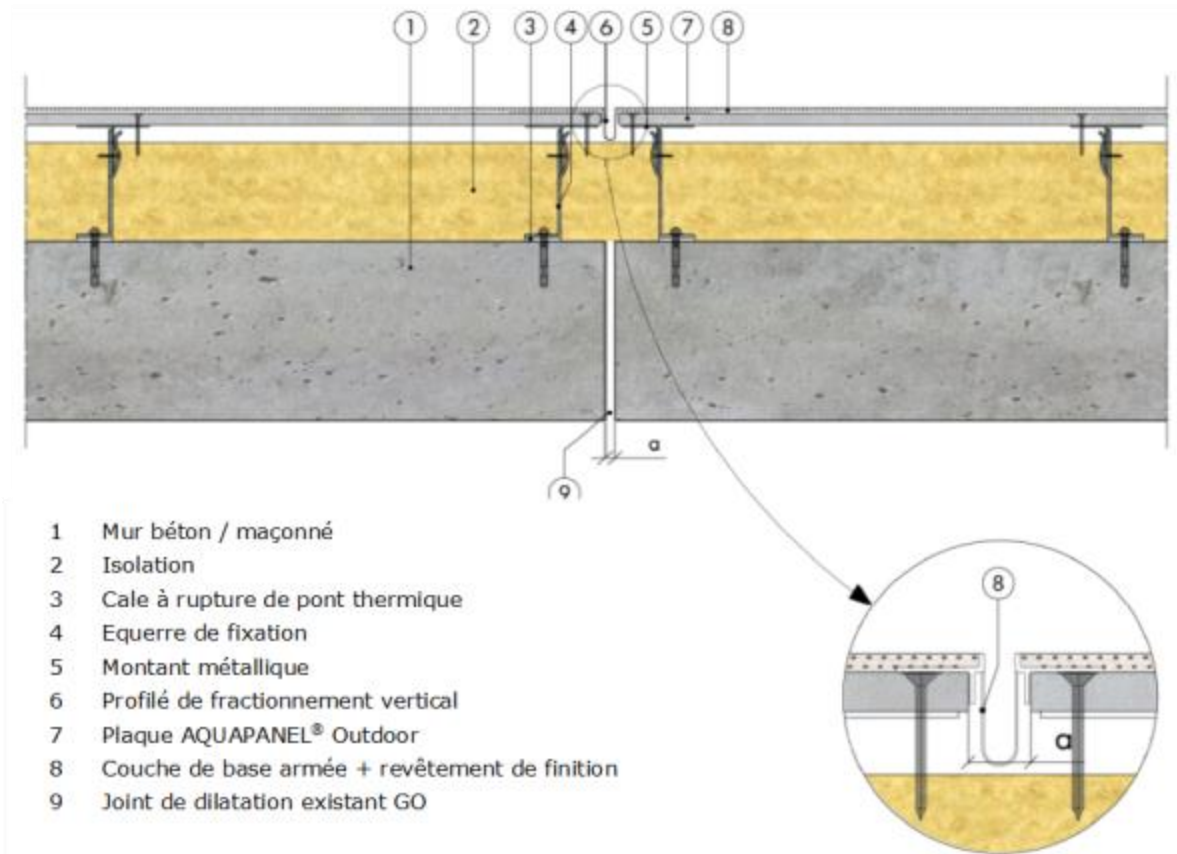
Traitement du joint de dilatation – Coupe verticale sur ossature métallique
